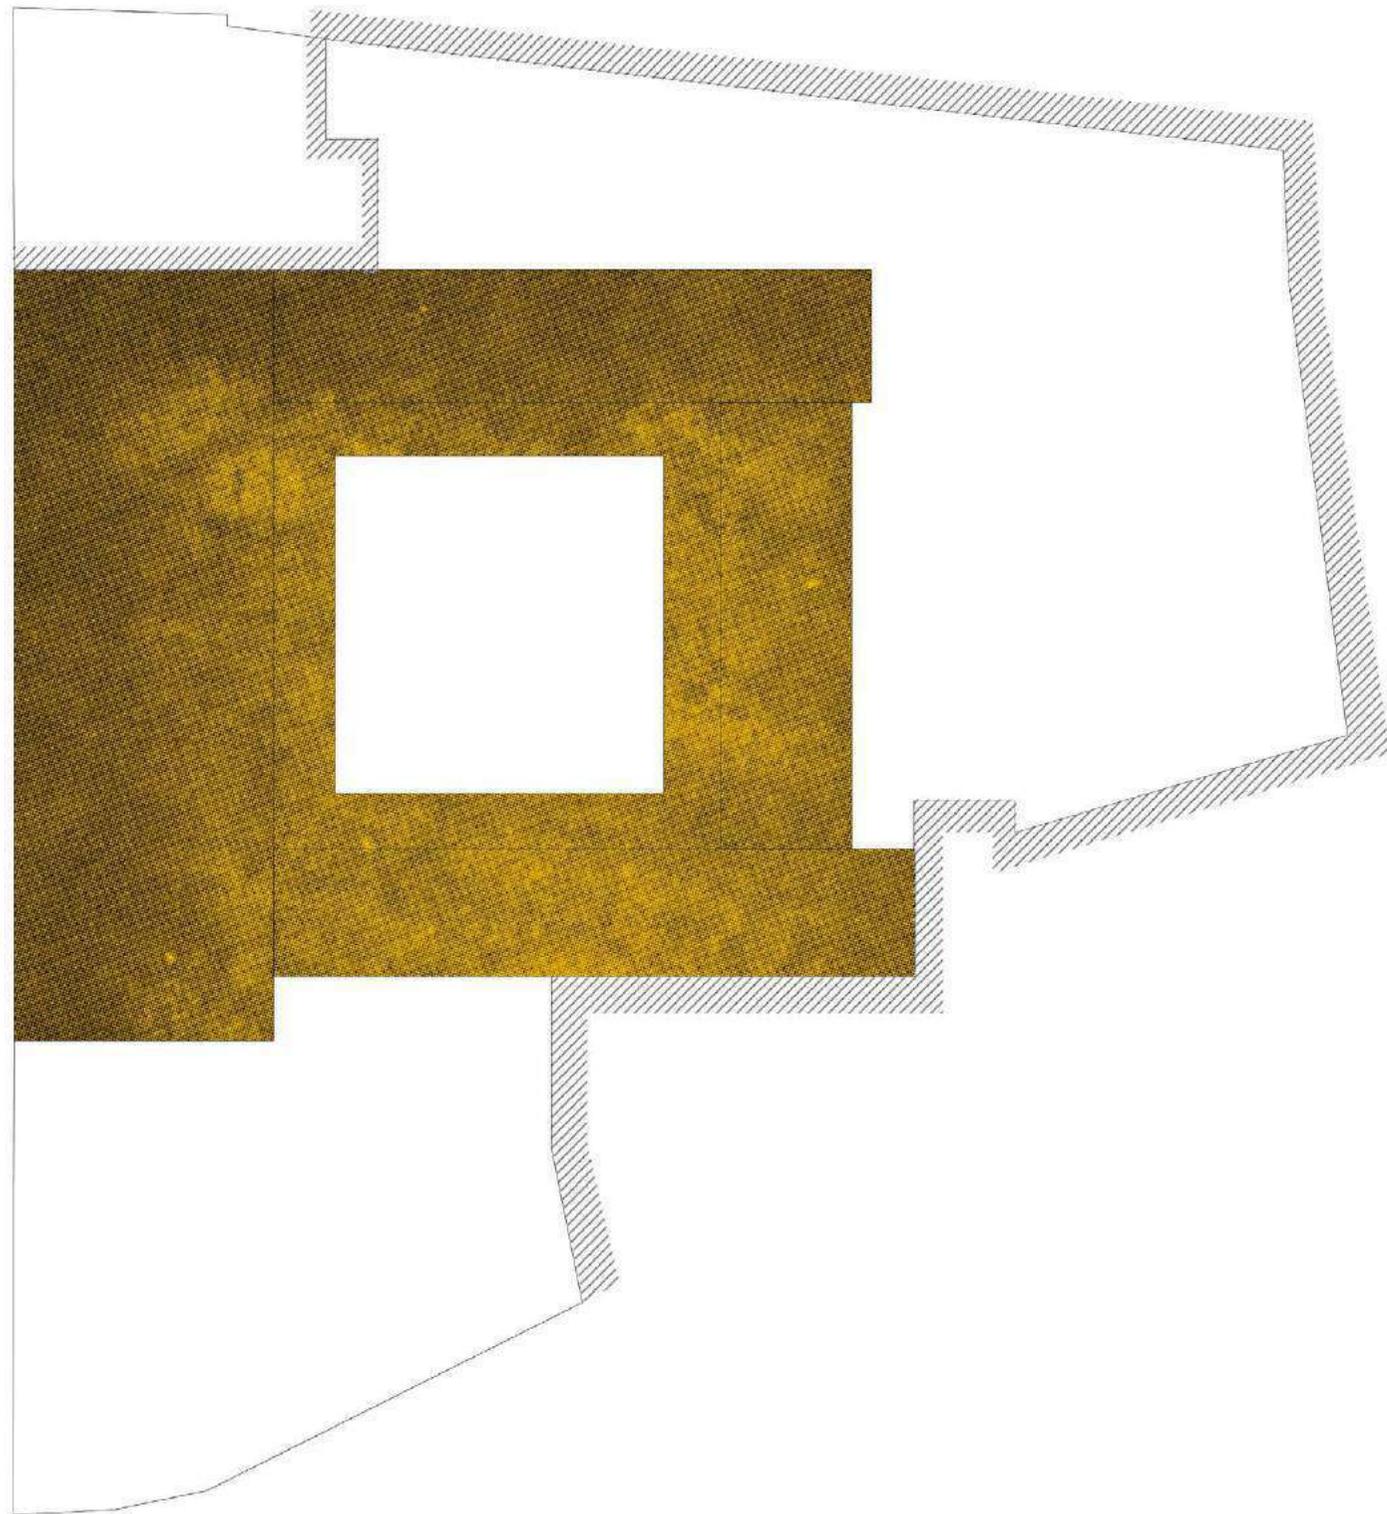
Plano de confrontación entre lo construido y lo vacío en el conjunto. Fuente: Elaboración propia.
